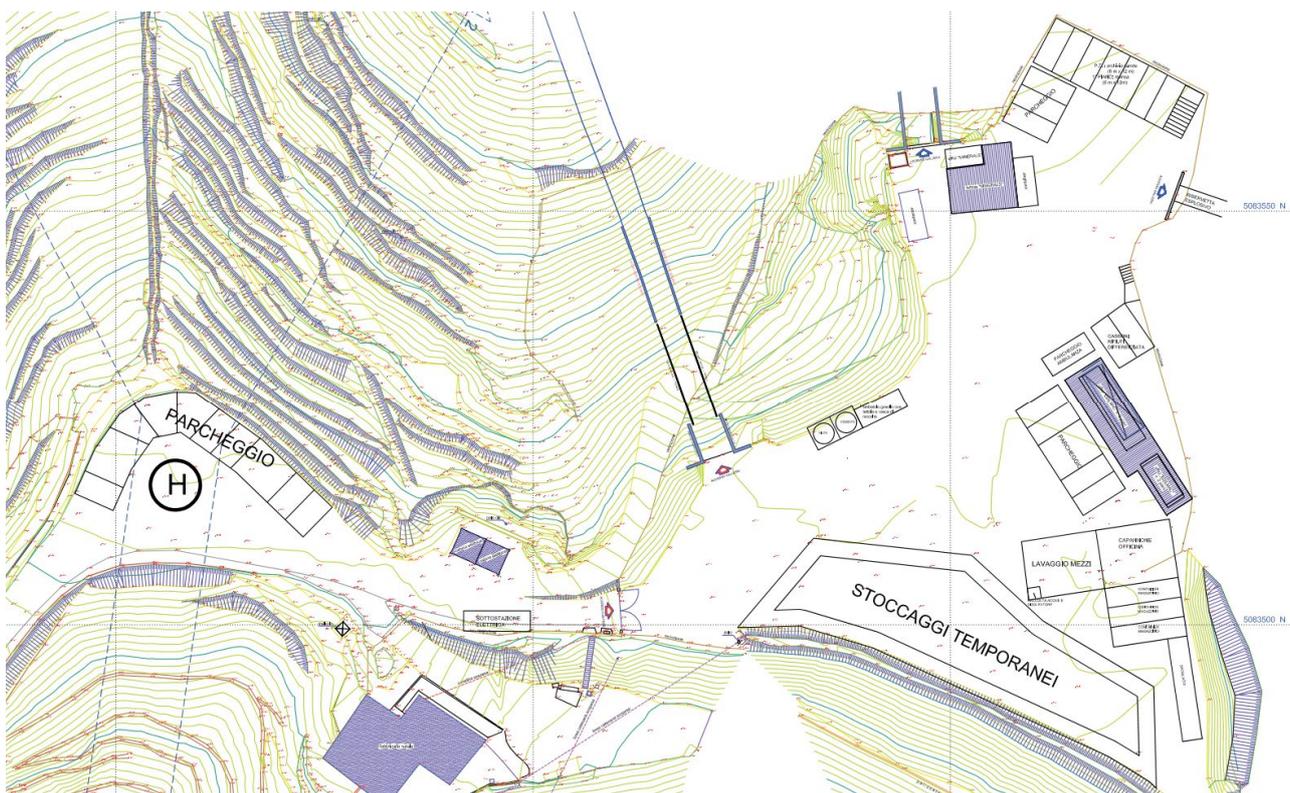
Layout dell'area logistica di cantiere in loc. Ca' Pasi.
